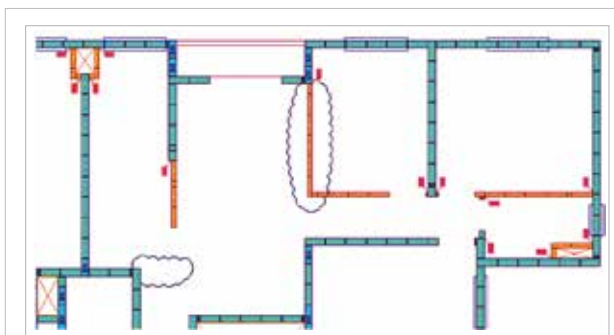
Situação de arquitetura pouco favorável ao emprego de lajes pré-moldadas
